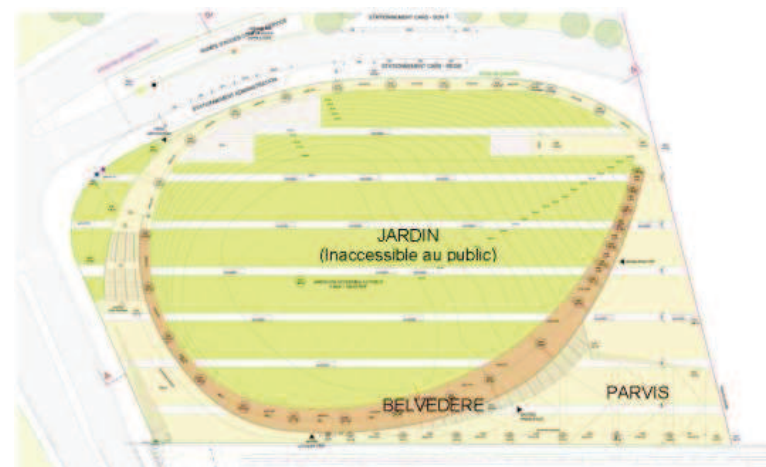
PLAN MASSE JARDIN – BELVEDERE
